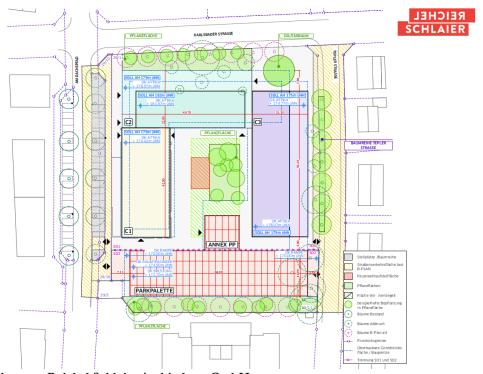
Planung, Reichel Schlaier Architekten GmbH
